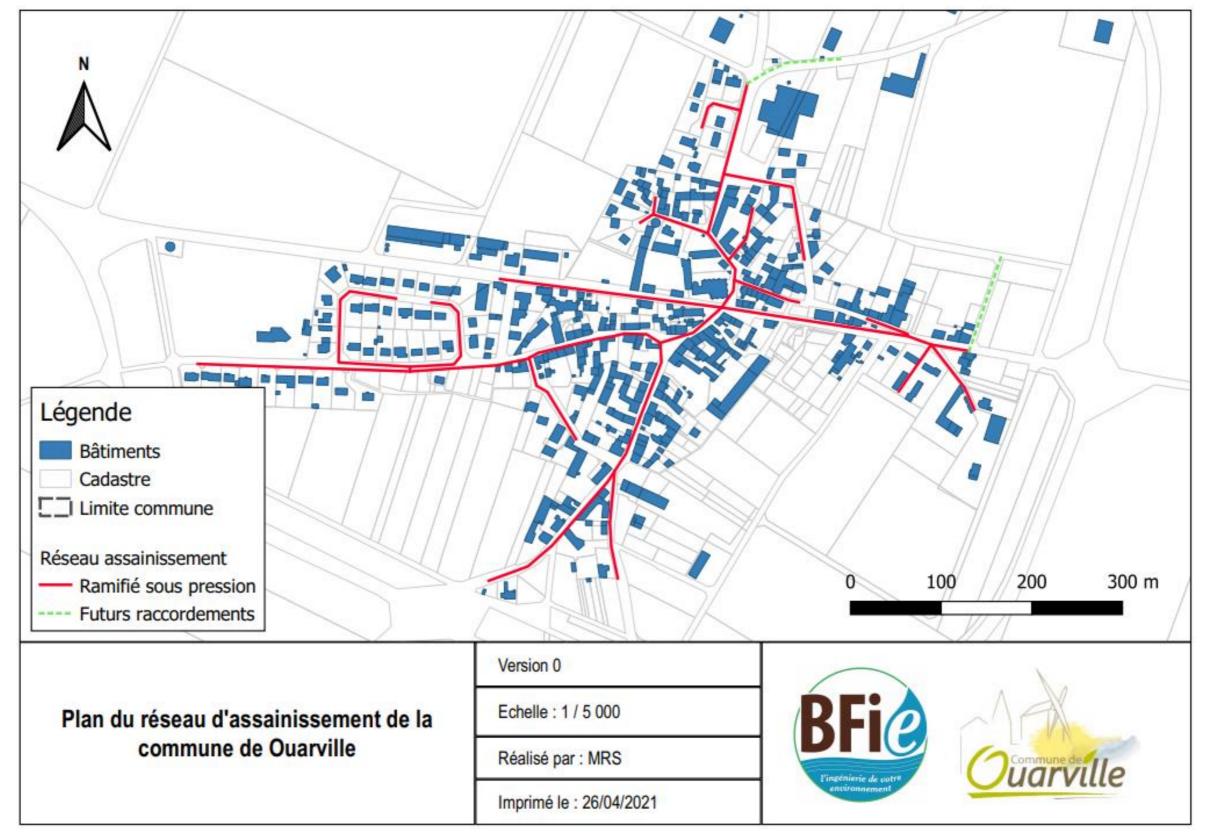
Plan du réseau d'assainissement de la commune de Ouarville - Zoom sur la commune
